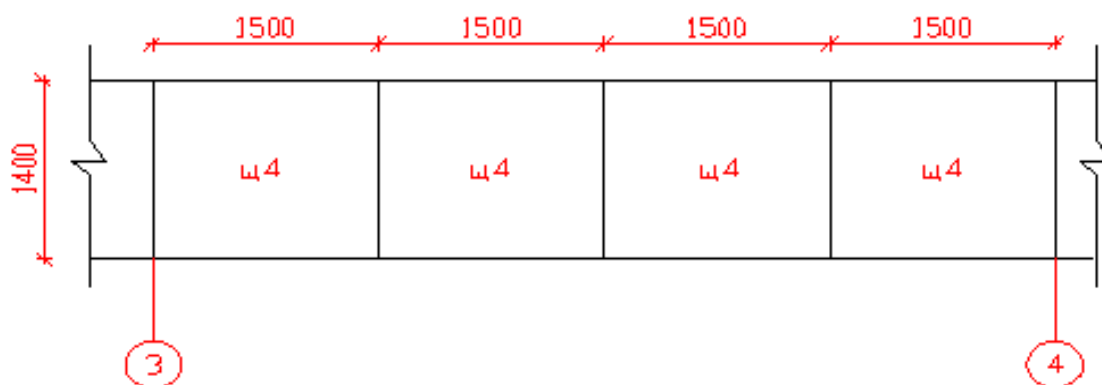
Схема раскладки щитов ленточного фундамента
